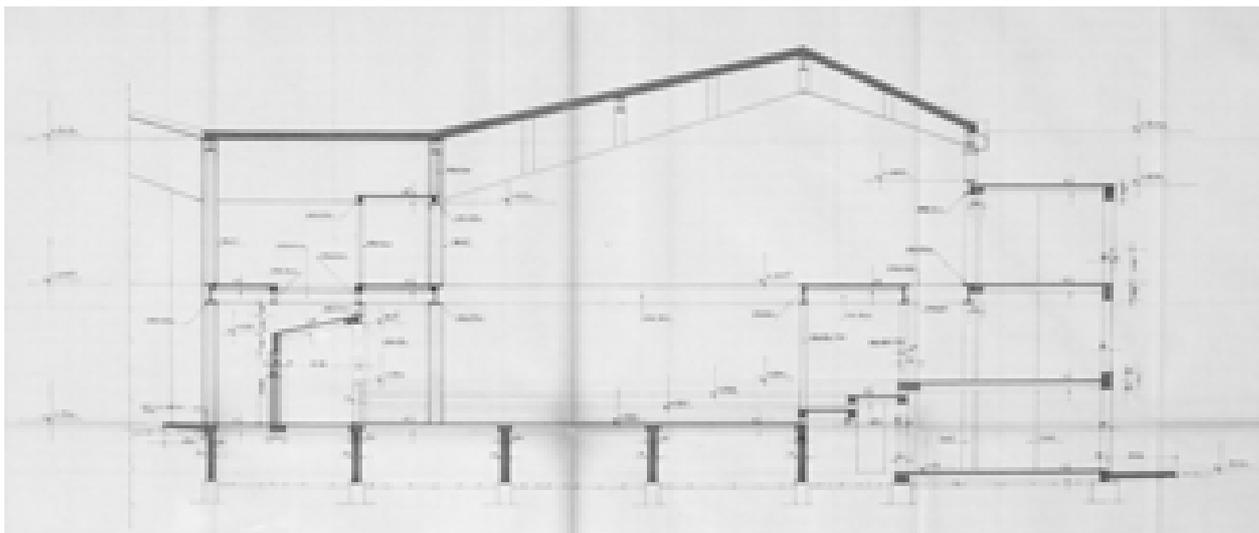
Sezione BB – OPEN –24/01/1990 (AABS-1996.230)
